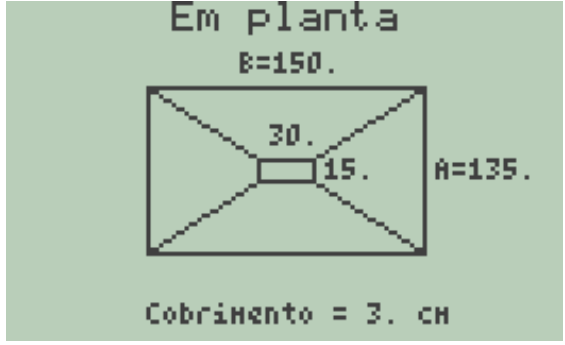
Sapata isolada - Detalhe da sapata - Dimensões em planta.
